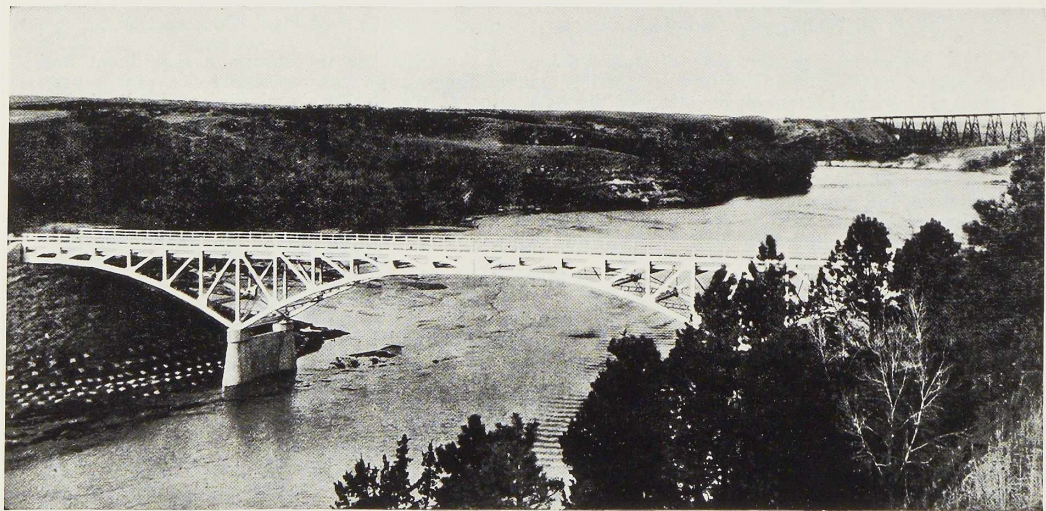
Pont de Bryan sur la Niobrara, la portée centrale a 44 mètres. Les piles et les culées sont fondées sur des poutrelles à larges ailes.
